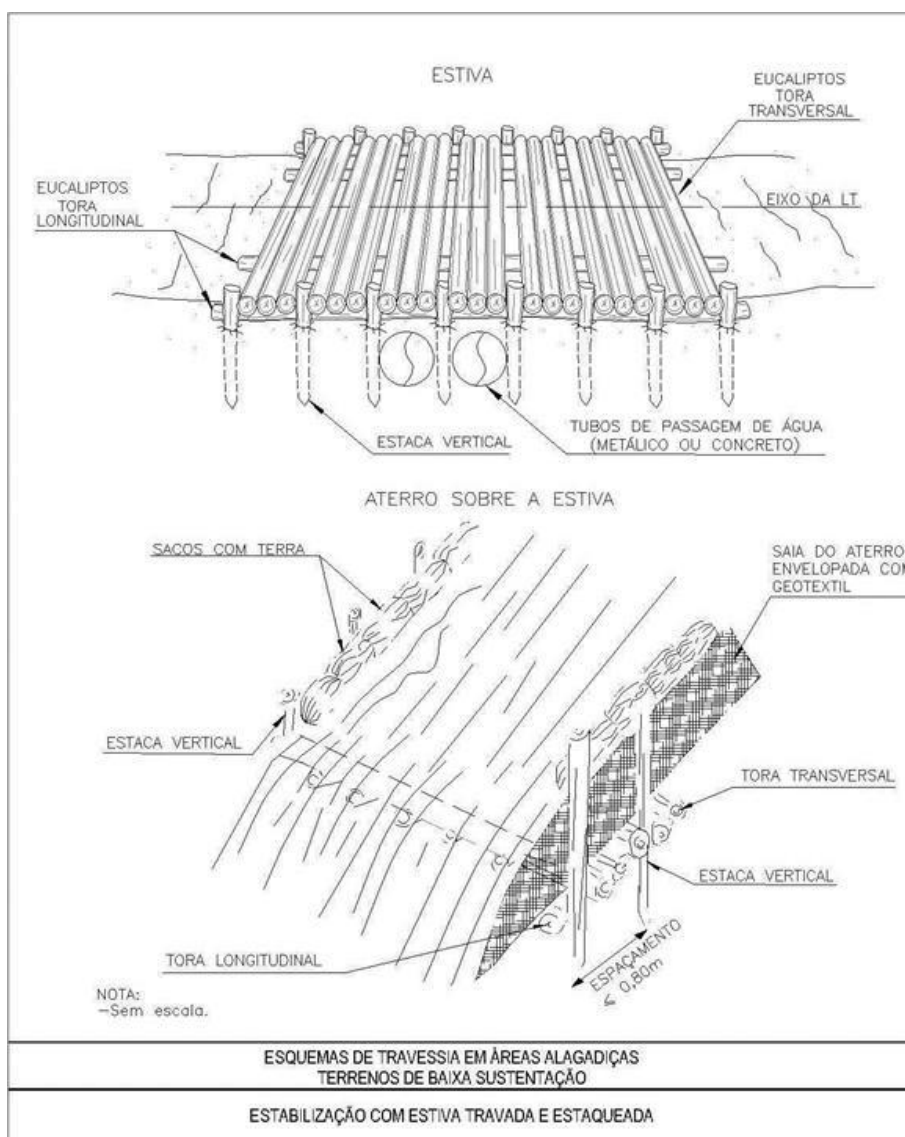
Construção em áreas de várzea em terrenos de baixa sustentação.
